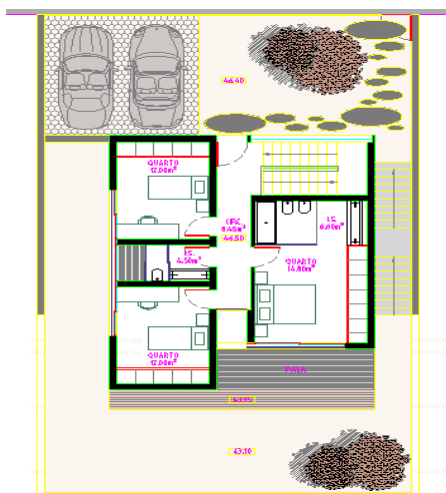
Planta do piso 0, moradia da Ajuda
